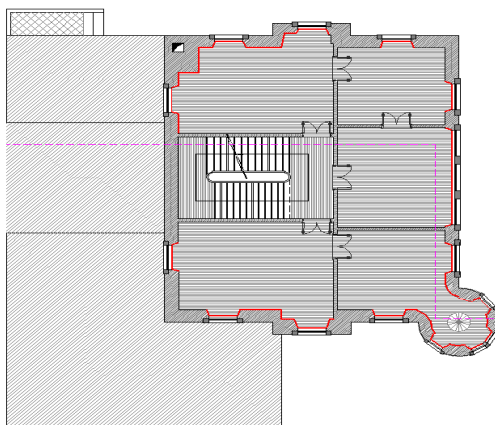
Localização em planta das eflorescências no reboco interior das fachadas na planta do 1º piso.
